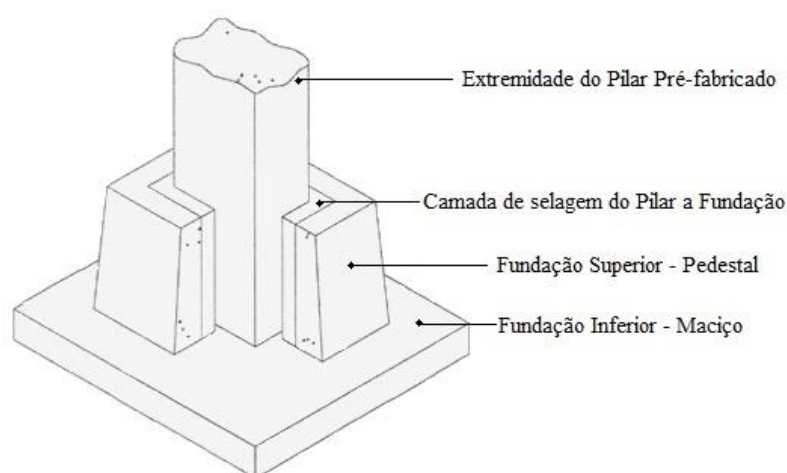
Ligação Pilar – Fundação por encaixe [46]
